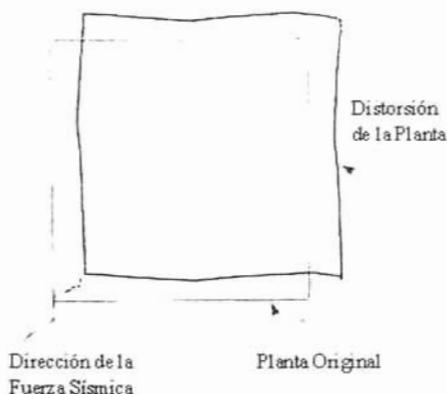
Distorsión en el plano ante fuerza sísmicas en dirección diagonal, cuando el sistema de piso no constituye un diafragma rígido.
